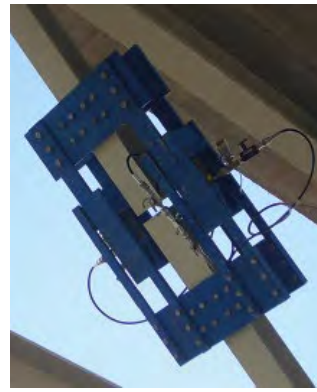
Hilfskonstruktion mit Hydraulikpressen zum Vorspannen (© 2014, HOCHTIEF)
